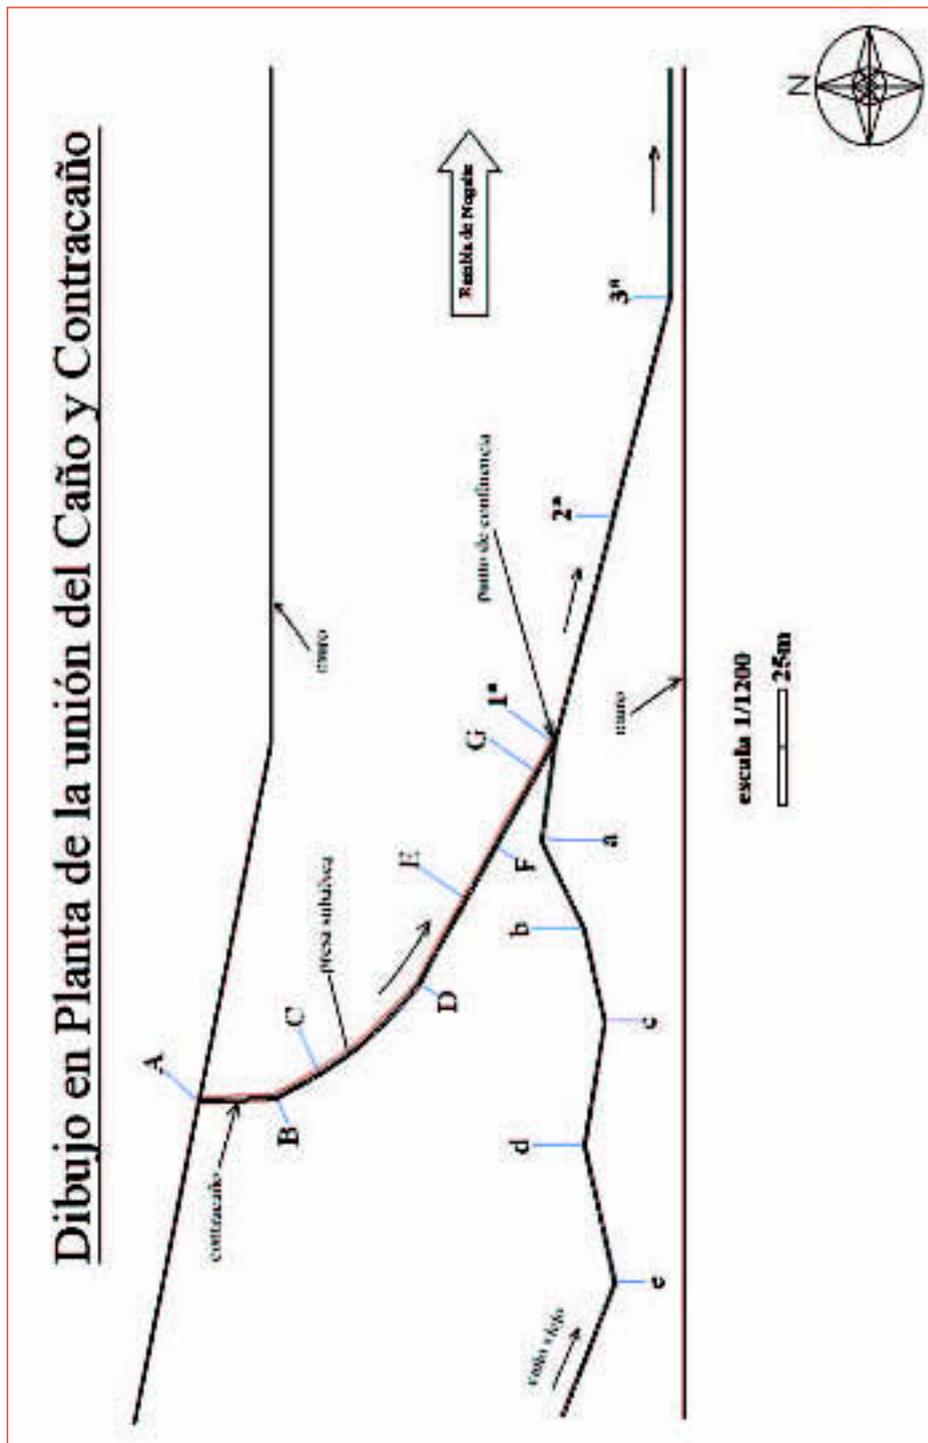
Dibujo en planta de la unión del Caño y Contracaño.
